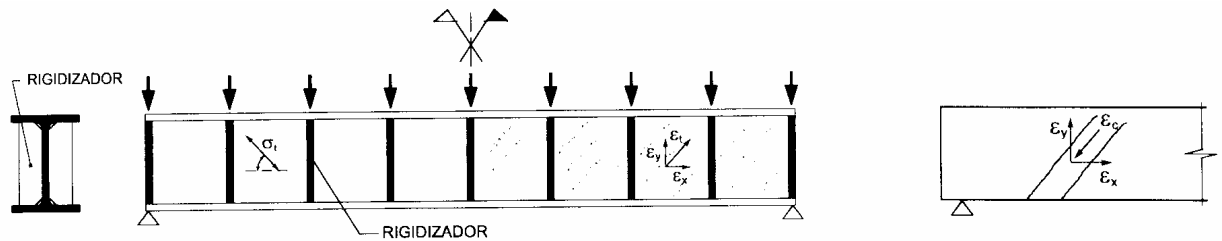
Ensayos en vigas metálicas de alma delgada con rigidizadores (Wagner)
